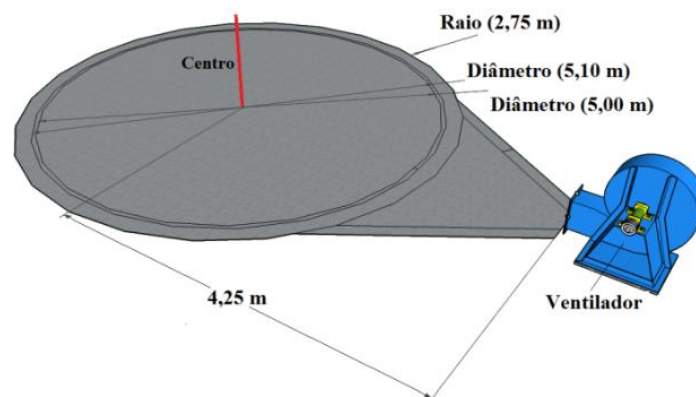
Detalhe da marcação da planta baixa, para construção do secador.
